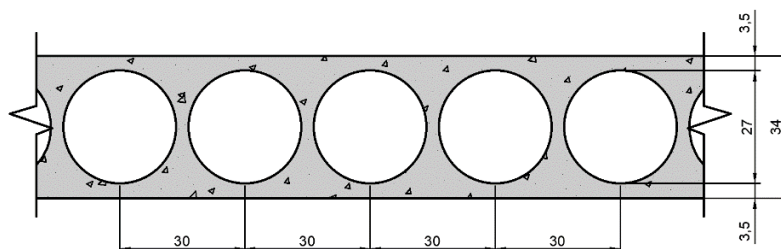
Projeto B3 – Seção transversal da laje *BubbleDeck* (dimensões em cm).
